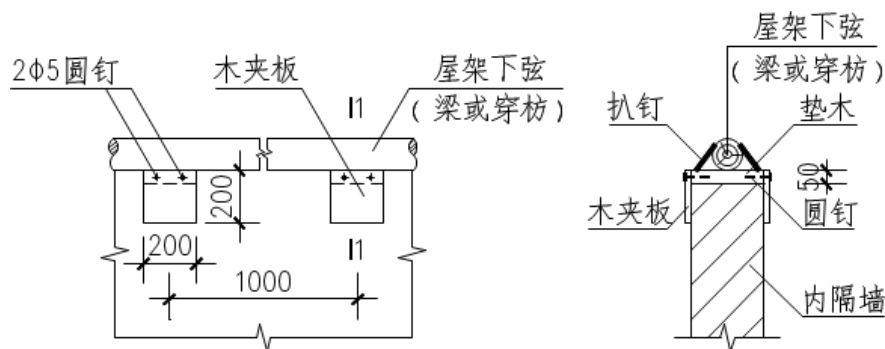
内隔墙墙顶与屋架下弦的连接（单位：mm）
